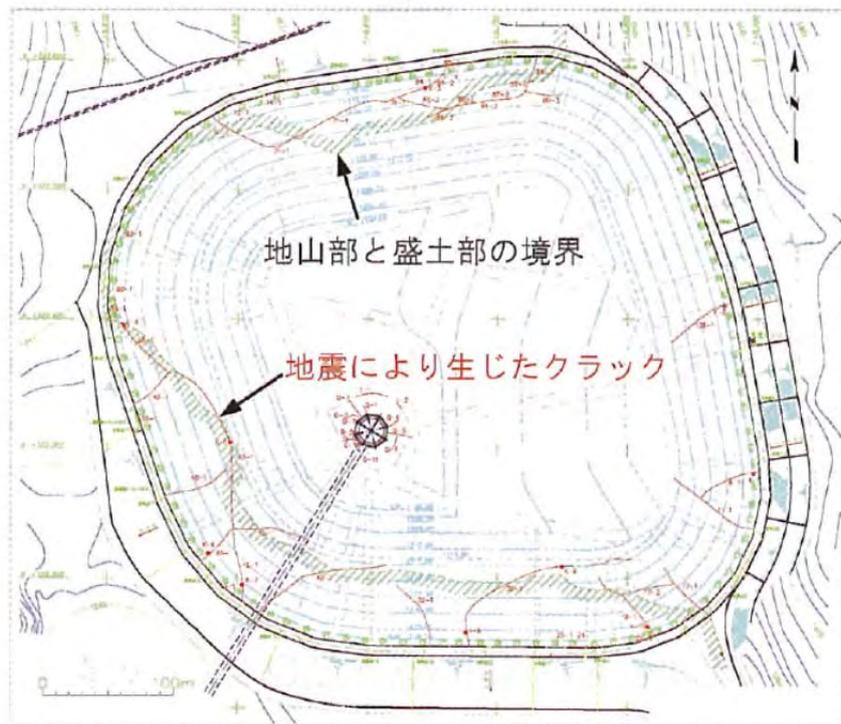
沼原ダム遮水壁クラック状況図(貯水池平面図)⁴⁻²⁸⁾
